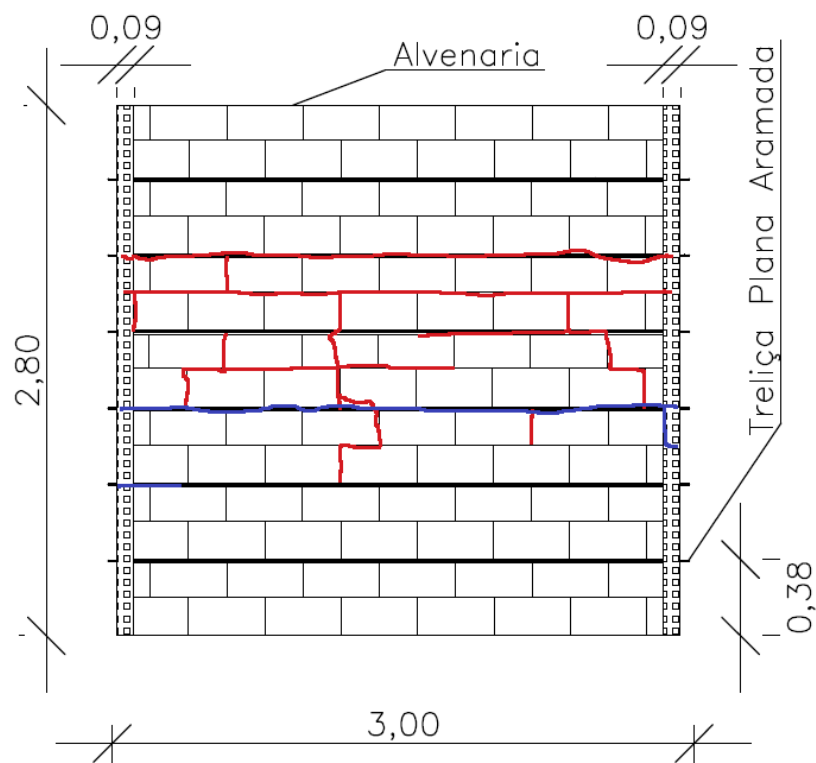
Mapeamento de fissuras da segunda alvenaria ALV – 4 (Vista frontal)
